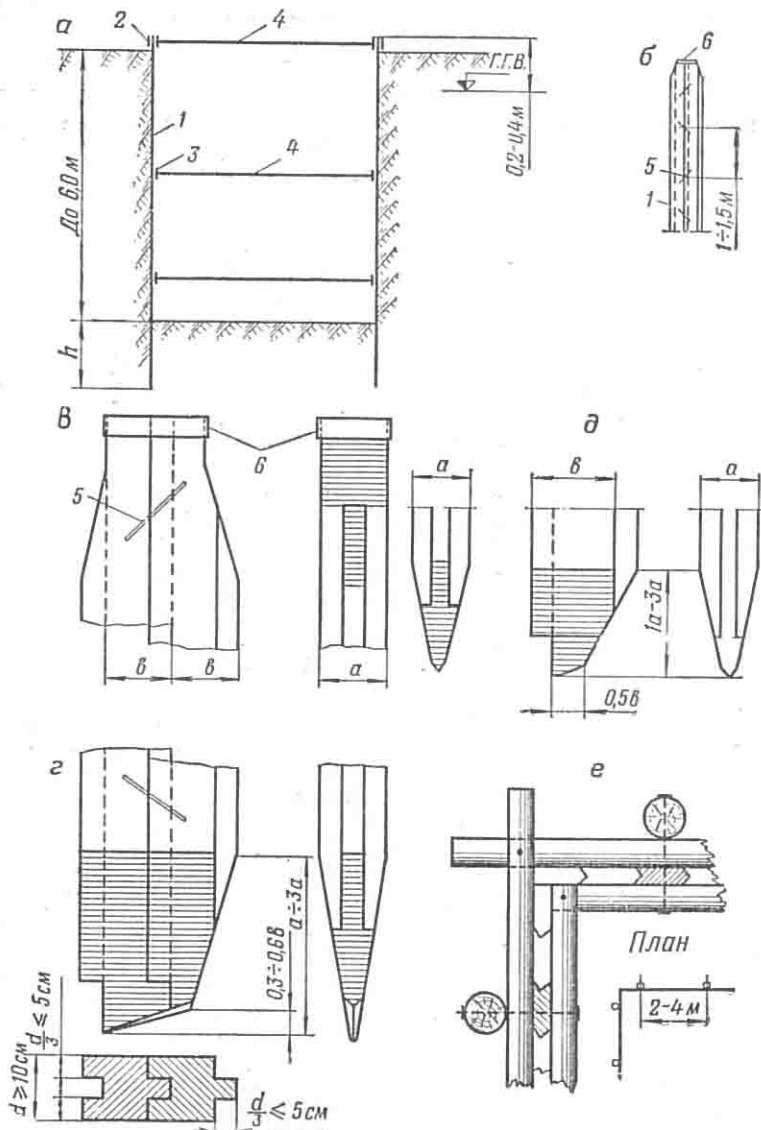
Деревянное брусчатое шпунтовое ограждение:
